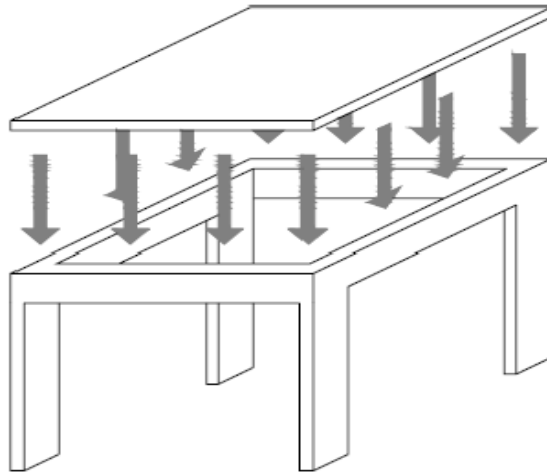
Laje maciça apoiada sobre vigas (Oliveira, 2012)
